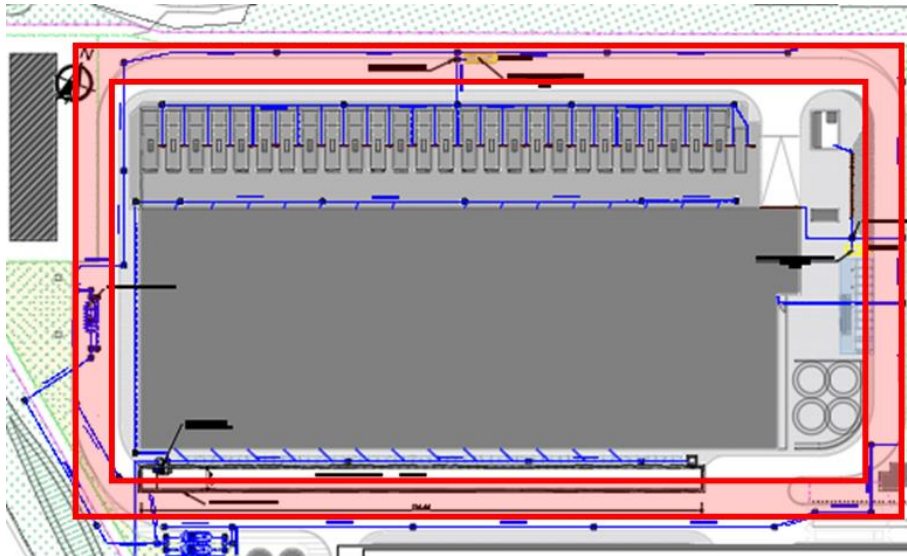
Rete di collettamento acque meteoriche dalle superfici stradali
